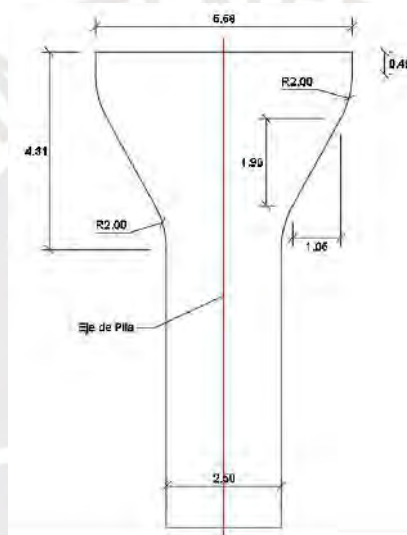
Sección Transversal Pila. Alternativa Cajón de Hormigón
